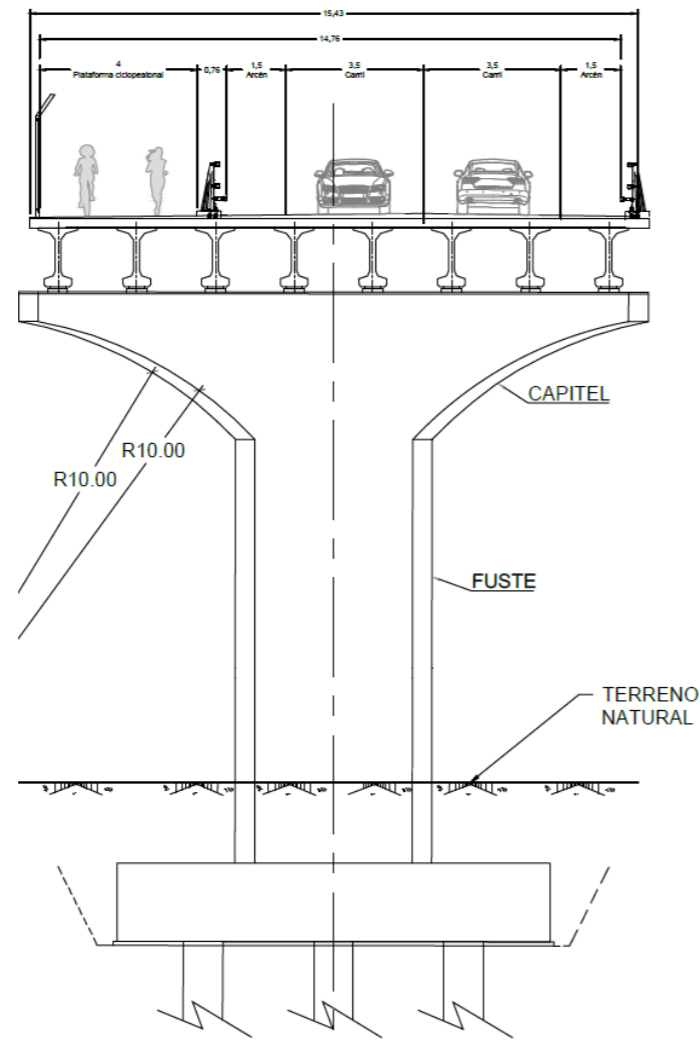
Sección transversal de apoyo de tablero en pilas tipo palmera.
